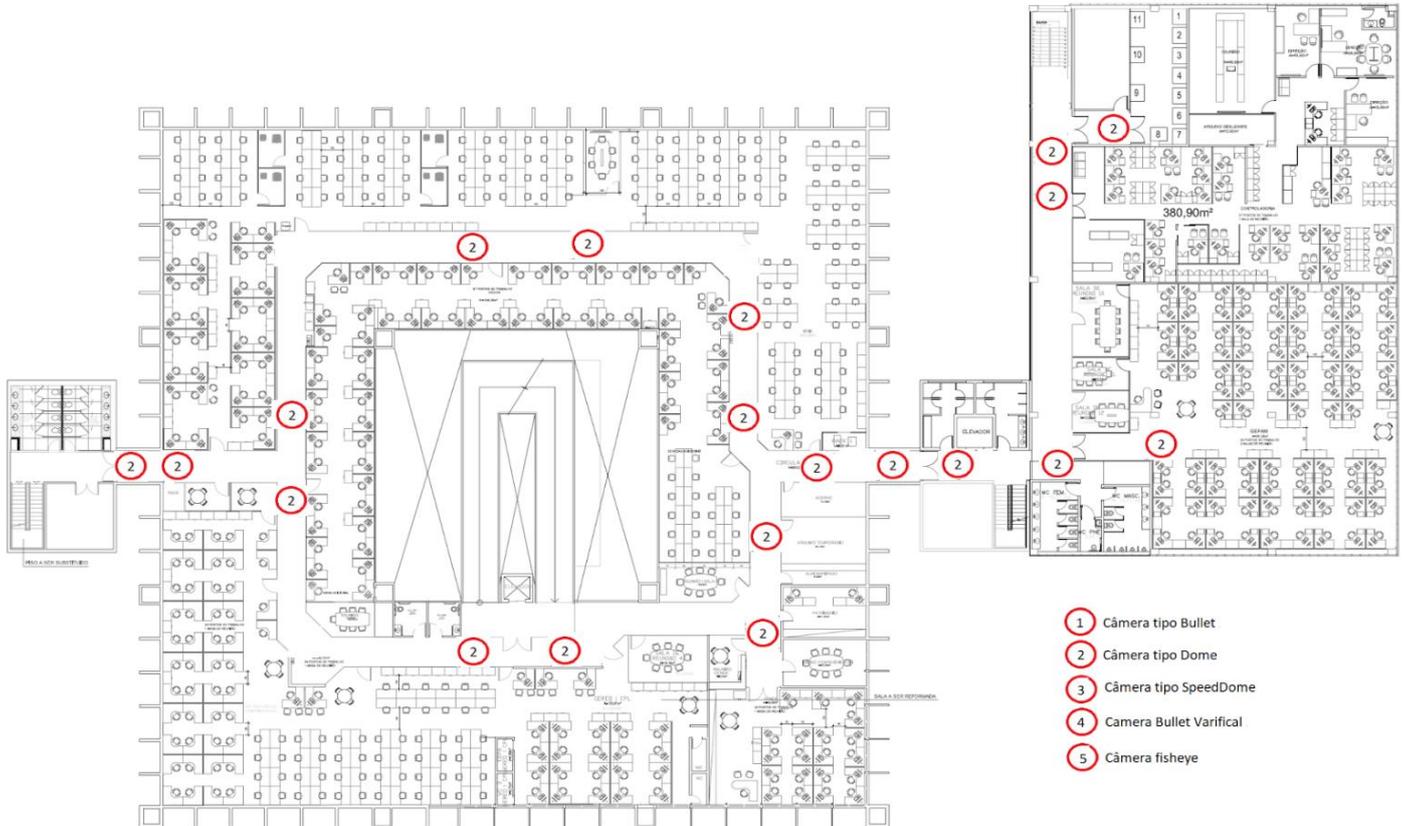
Esboço de posicionamento de câmeras para o segundo pavimento prédio principal;
